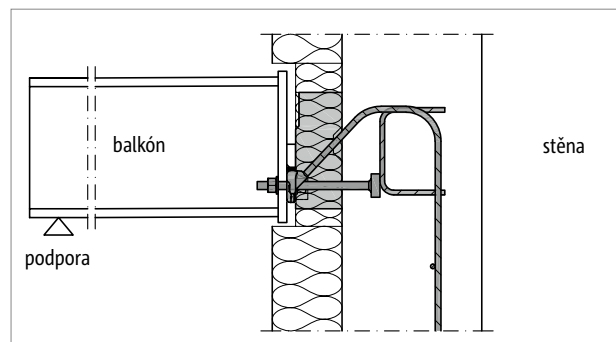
Schöck Isokorb® T typ SQP: Napojení na železobetonovou stropní desku; izolant uvnitř vnějšího zateplení
